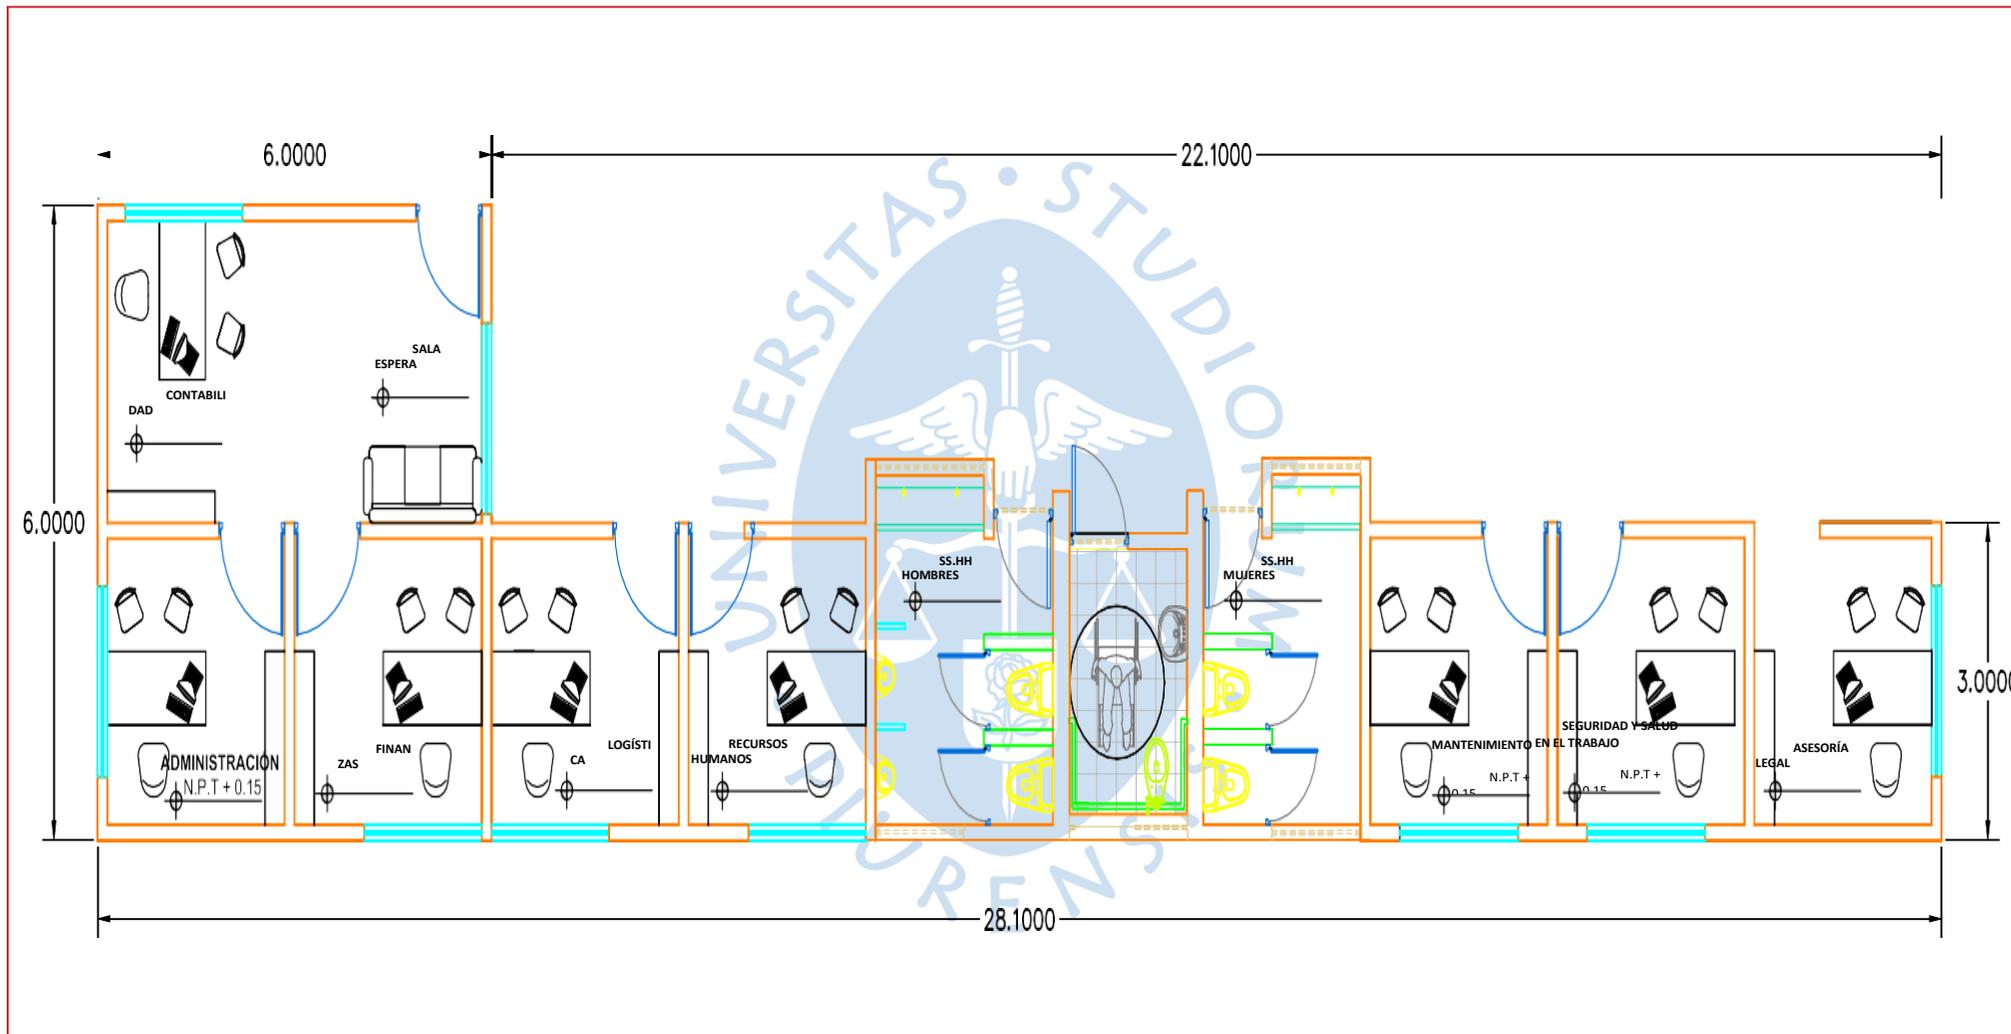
Diseño del plano de la Planta para la producción de sal de mesa
